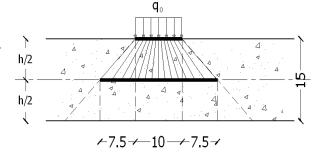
Répartition des charges sur la dalle d'ascenseur
